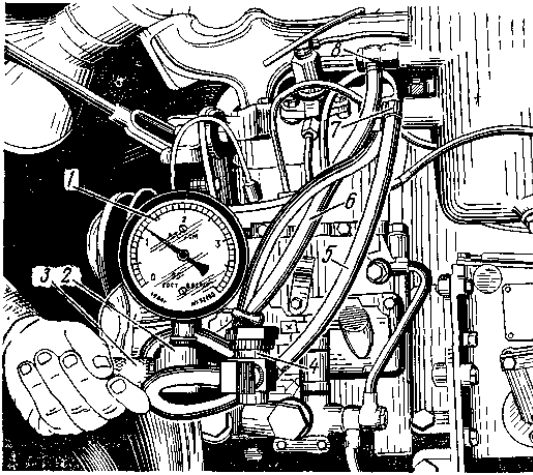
Проверка давления топлива в системе топливоподачи низкого давления при помощи приспособления КИ-4801:
